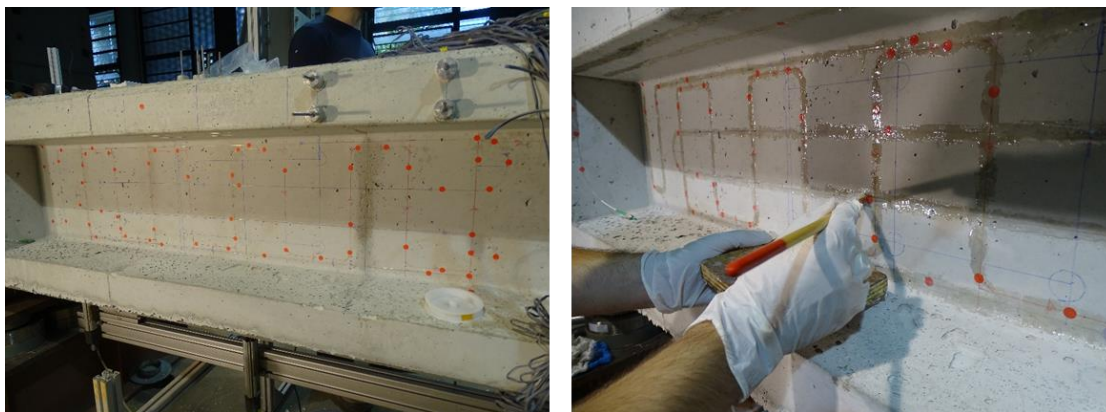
Presentación y pegado de la fibra óptica al alma de la viga de hormigón.
